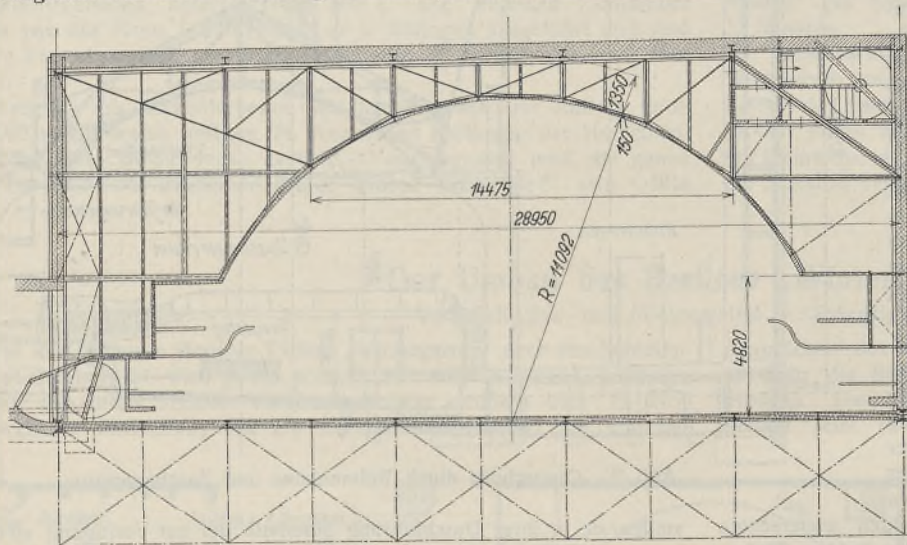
Decke über dem 2. Obergeschoß mit Windträger zwischen Kuppelhorizont und hinterer Längswand.
